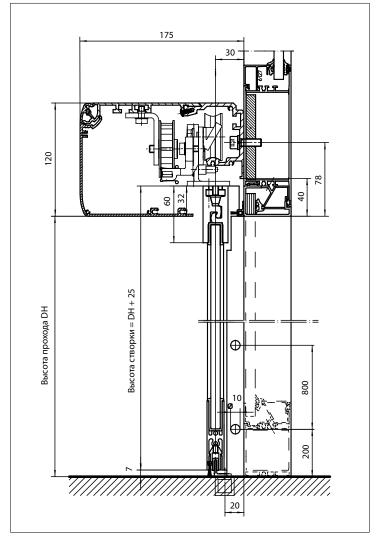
· Вертикальное сечение одинарного безопасного стекла
